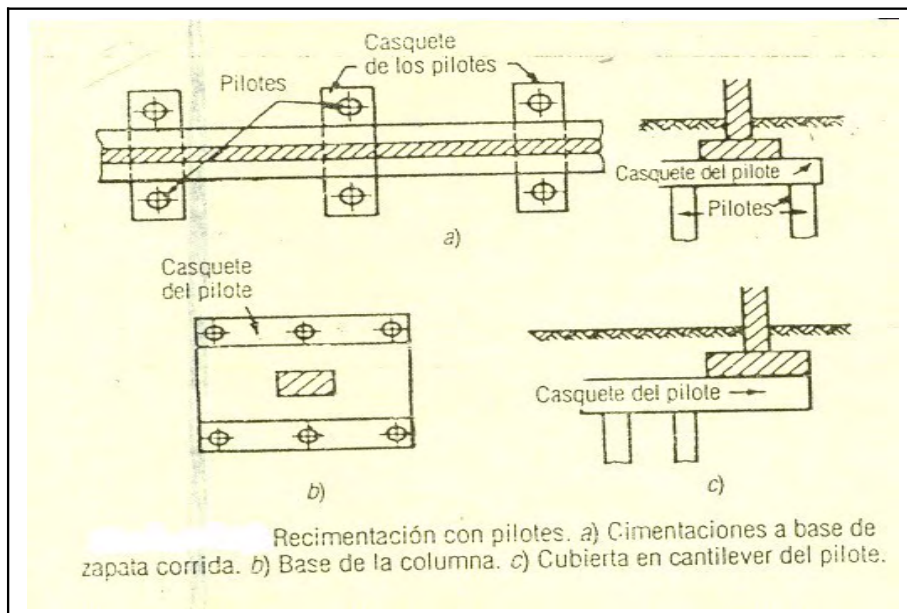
Esquemas de recimentación. (Recimentación con pilotes; a) Cimentaciones a base de zapata corrida, b) Base de la columna, c) Cubierta en cantiliver del pilote.)
